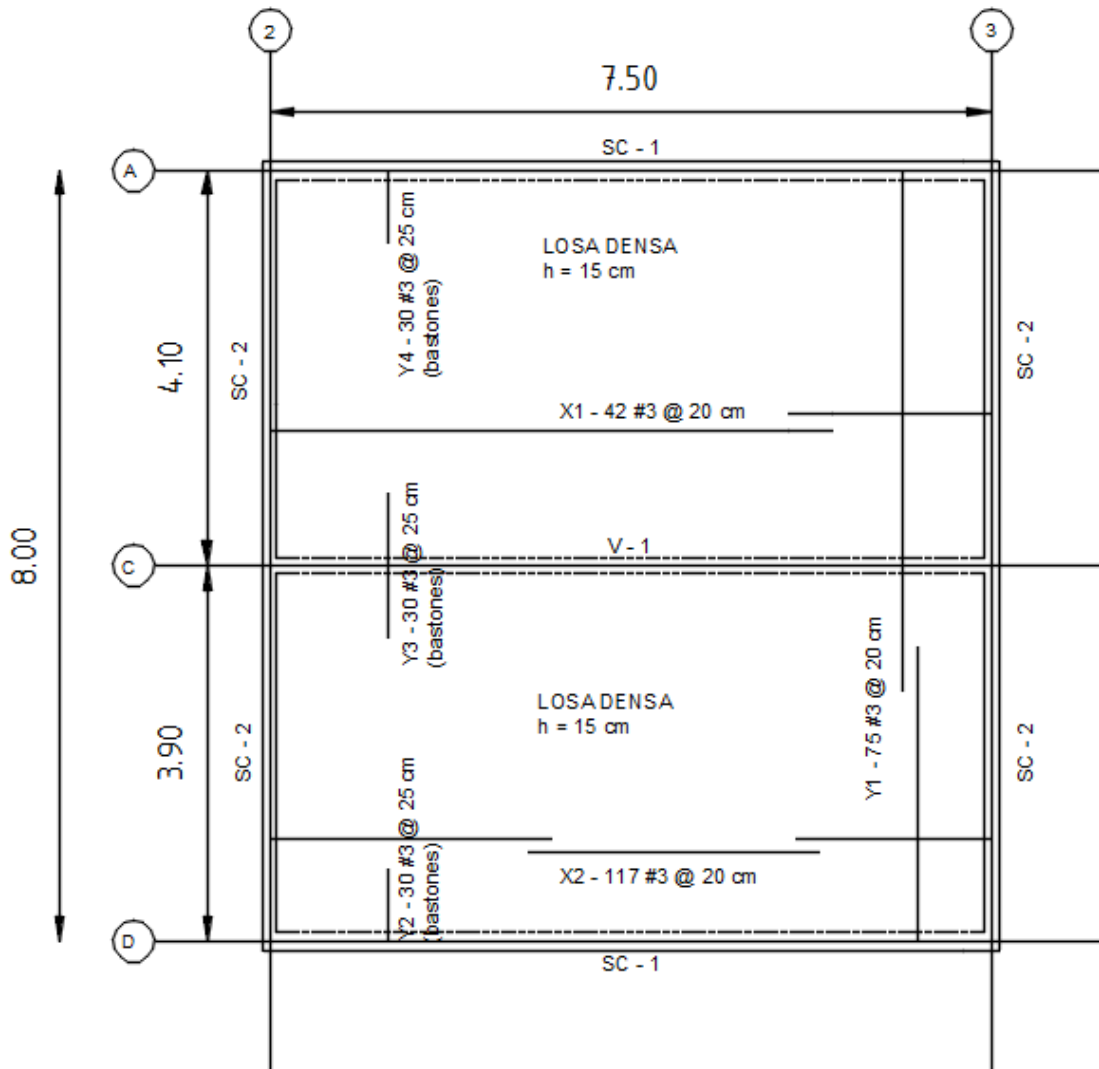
Plano de Taller de detallado de acero en losa densa, $h = 15$ cm.
